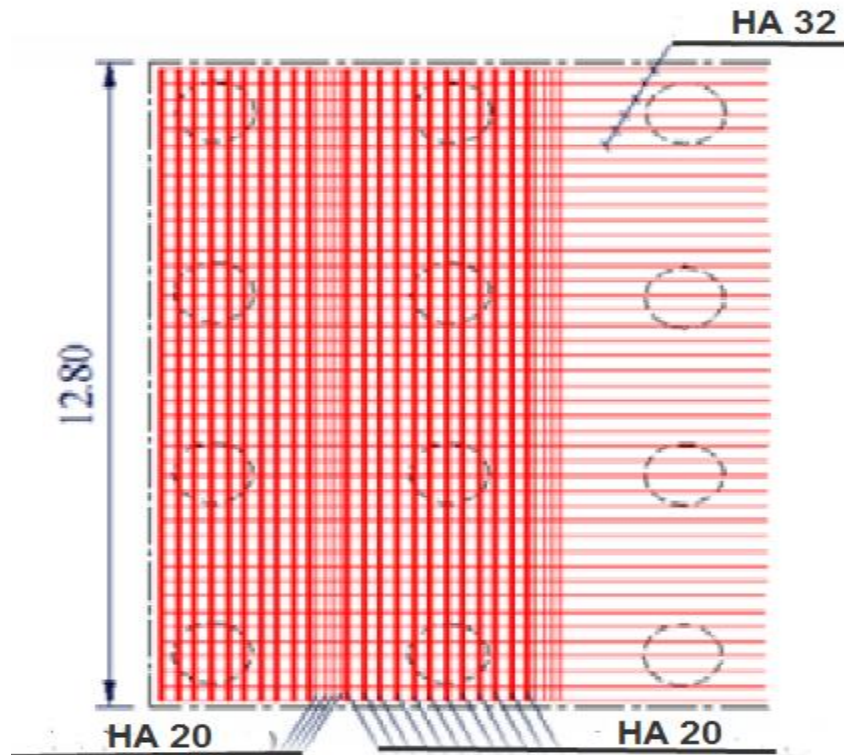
Ferrailage de la semelle (nappe inférieure)
